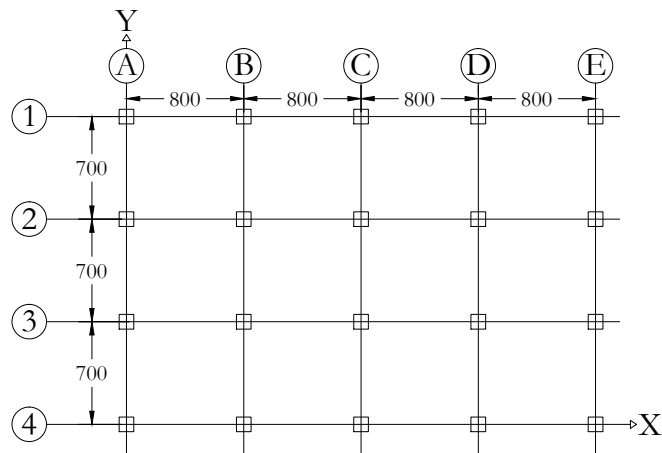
Planta tipo para los marcos de 15 y 25 niveles.
